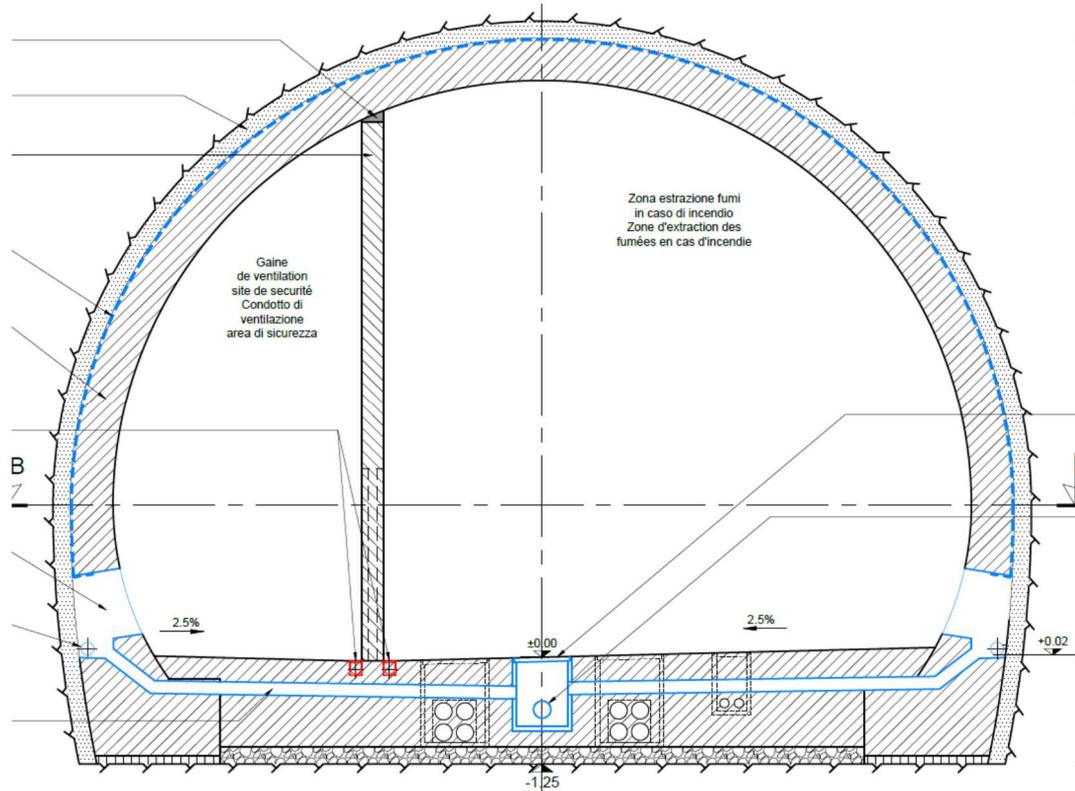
sistema di drenaggio della sezione corrente - galleria di connessione 2
